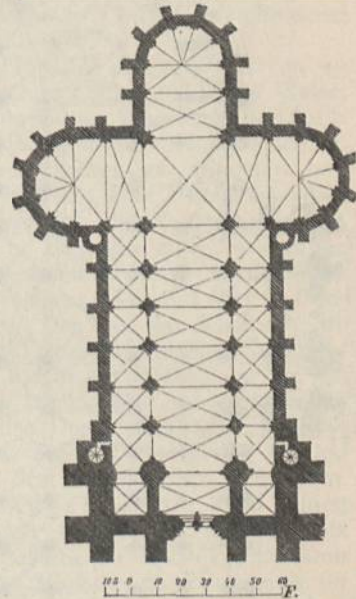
Grundriss der Elisabethkirche in Marburg.
